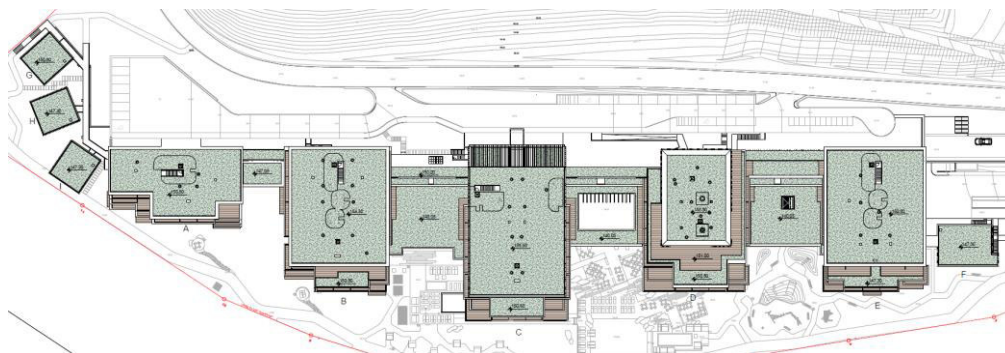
Coberturas ajardinadas previstas no projeto do Aparthotel.
